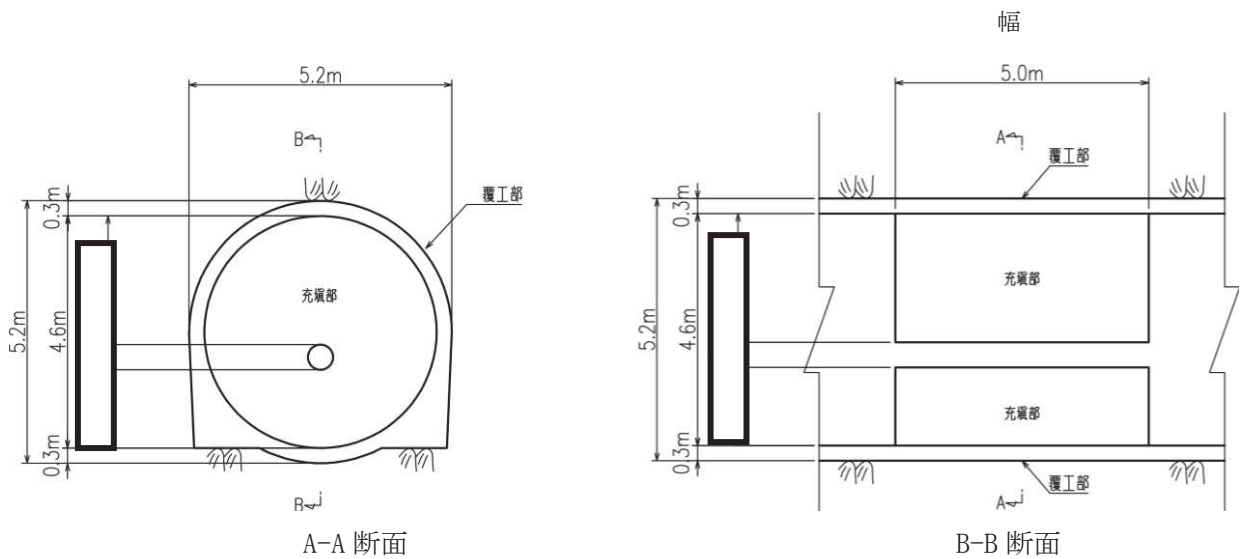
(2) 取放水路流路縮小工（第1号機放水路） 断面図
